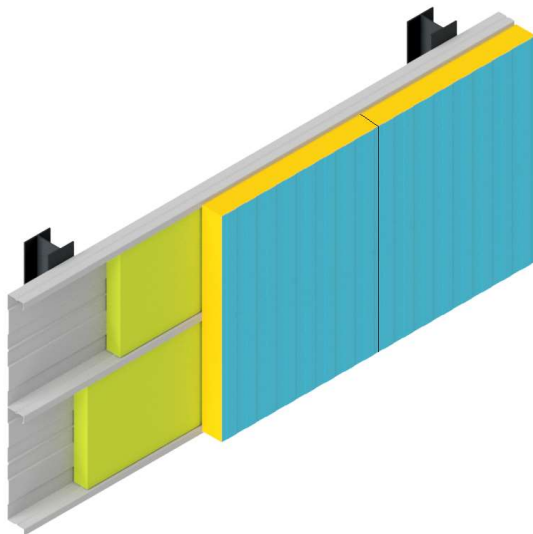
Hybridfassade mit vertikal verlegten Sandwichelementen
